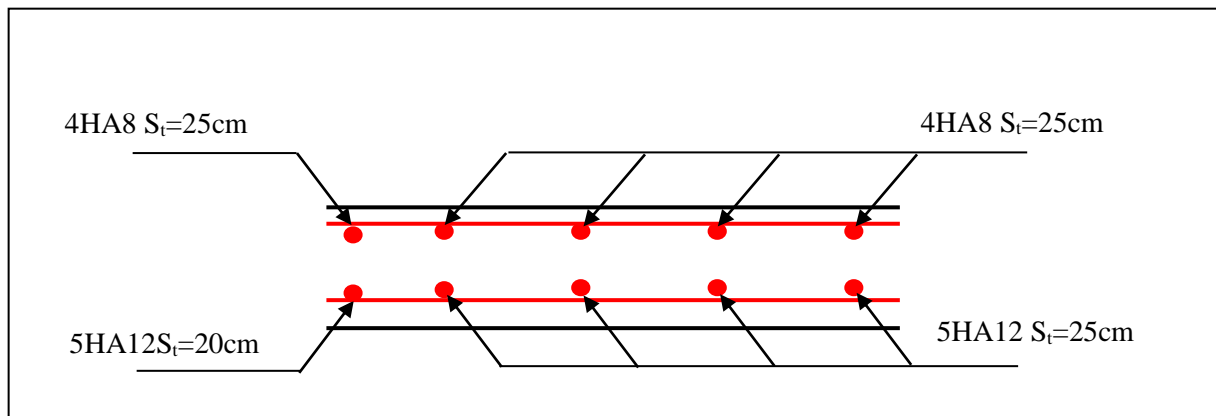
Vue en coupe du ferrailage de la dalle.
